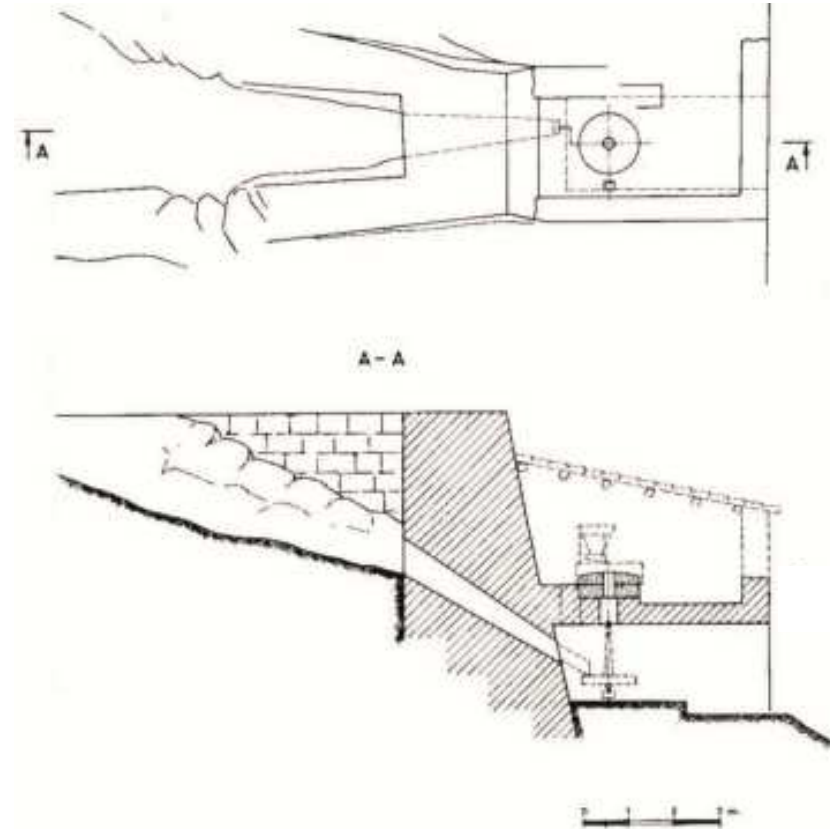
Planta y sección de molino de rampa y balsa adosados al casal molinero. 6.1.5.4-10
